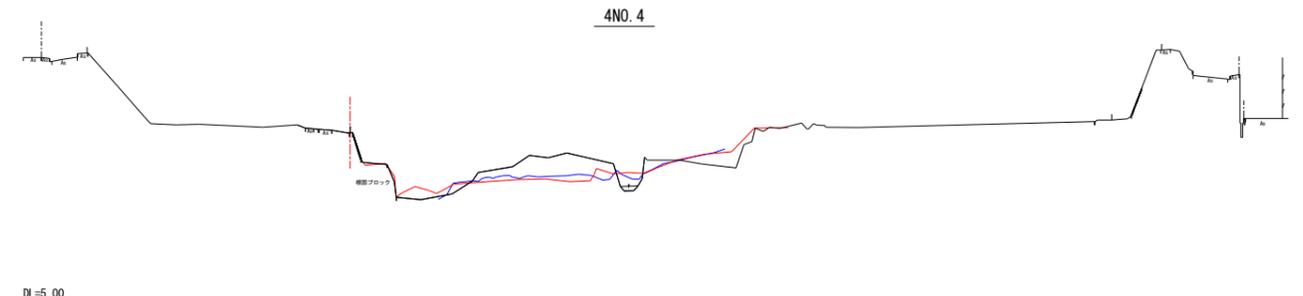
重ね合わせ横断面図 4No.4 (H21～H23)
